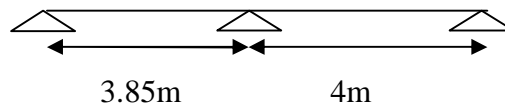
Schéma statique du 2<sup>ème</sup> type de poutrelles.
